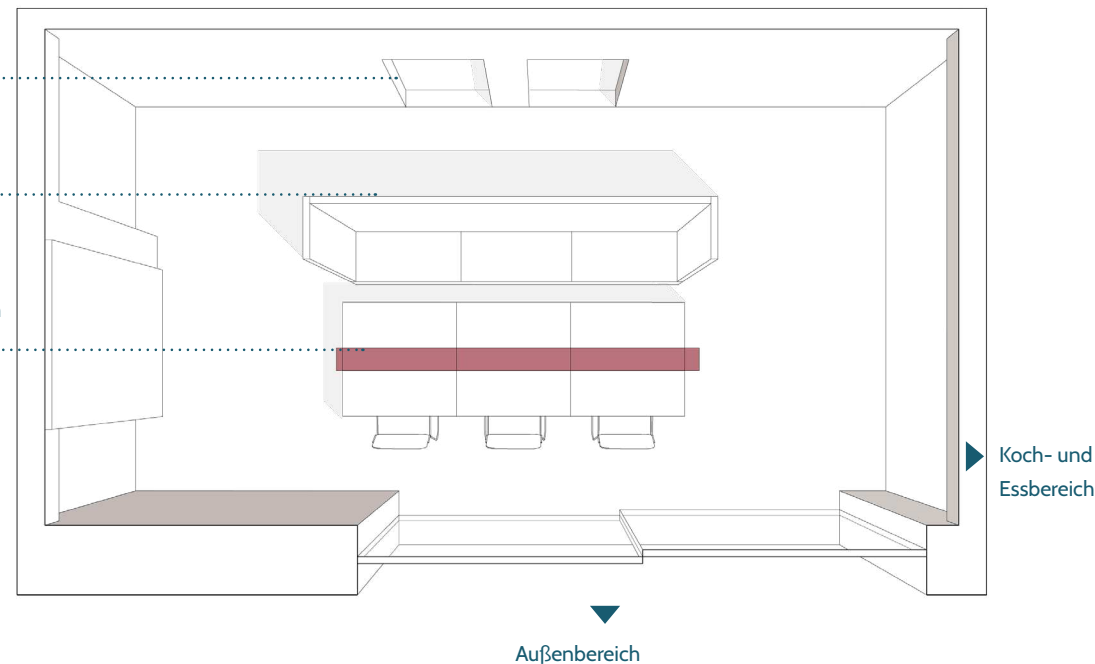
Grundriss - Kommunikationsbereich
